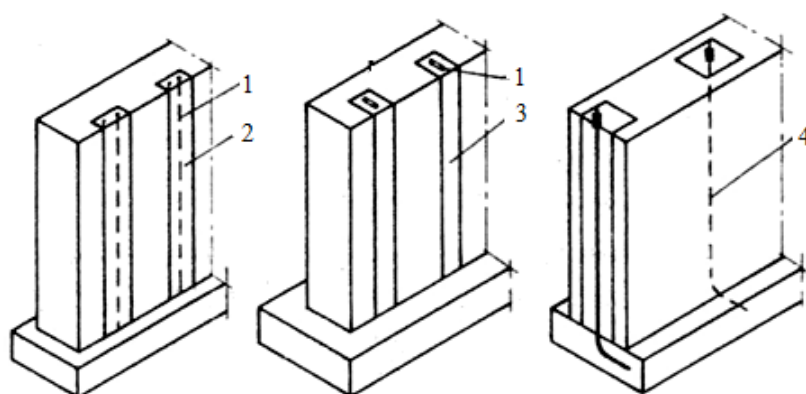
Армирование каменных стен подвалов вертикальными вставками 1, состоящими из каменных блоков корытообразного сечения, пространство между которыми заполнено арматурой и заливочным бетоном [7]
